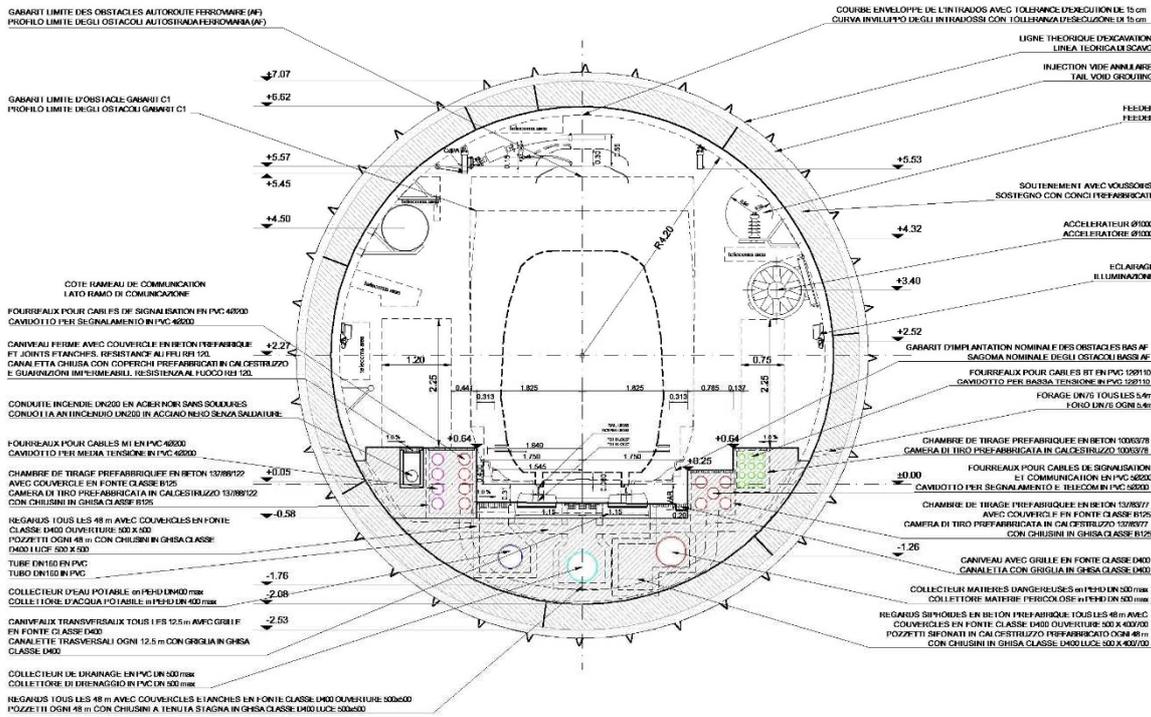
Sezione tipo Tunnel di Base: scavo con TBM scudata
